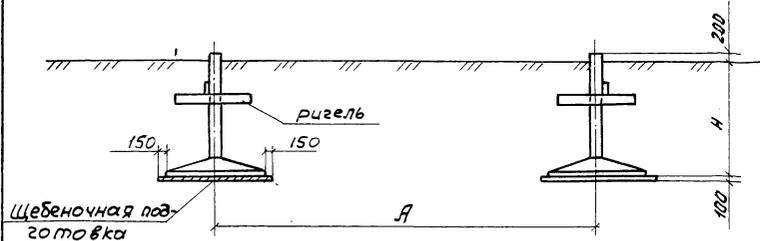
Схема фундаментов под промежуточно-угловую опору ПЧБ-20
